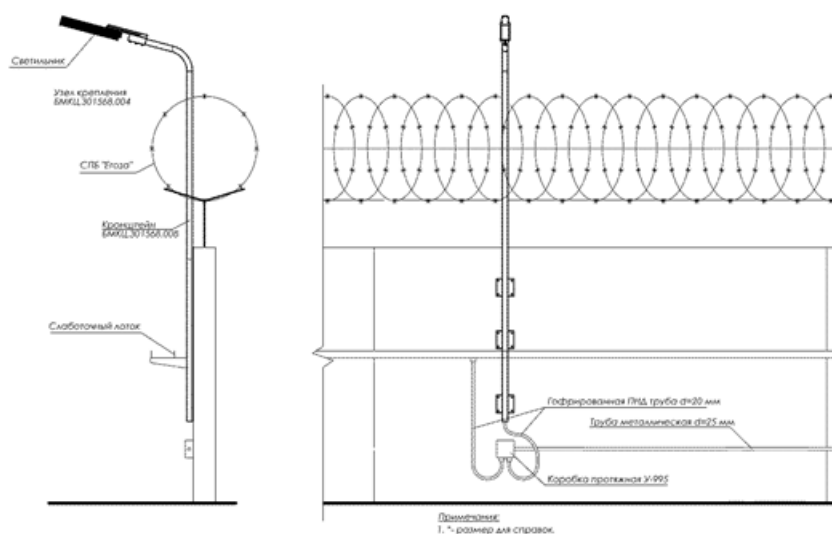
Монтаж светильника на бетонное ограждение (кронштейн "Контур-К", узел крепления "Контур-УК")
